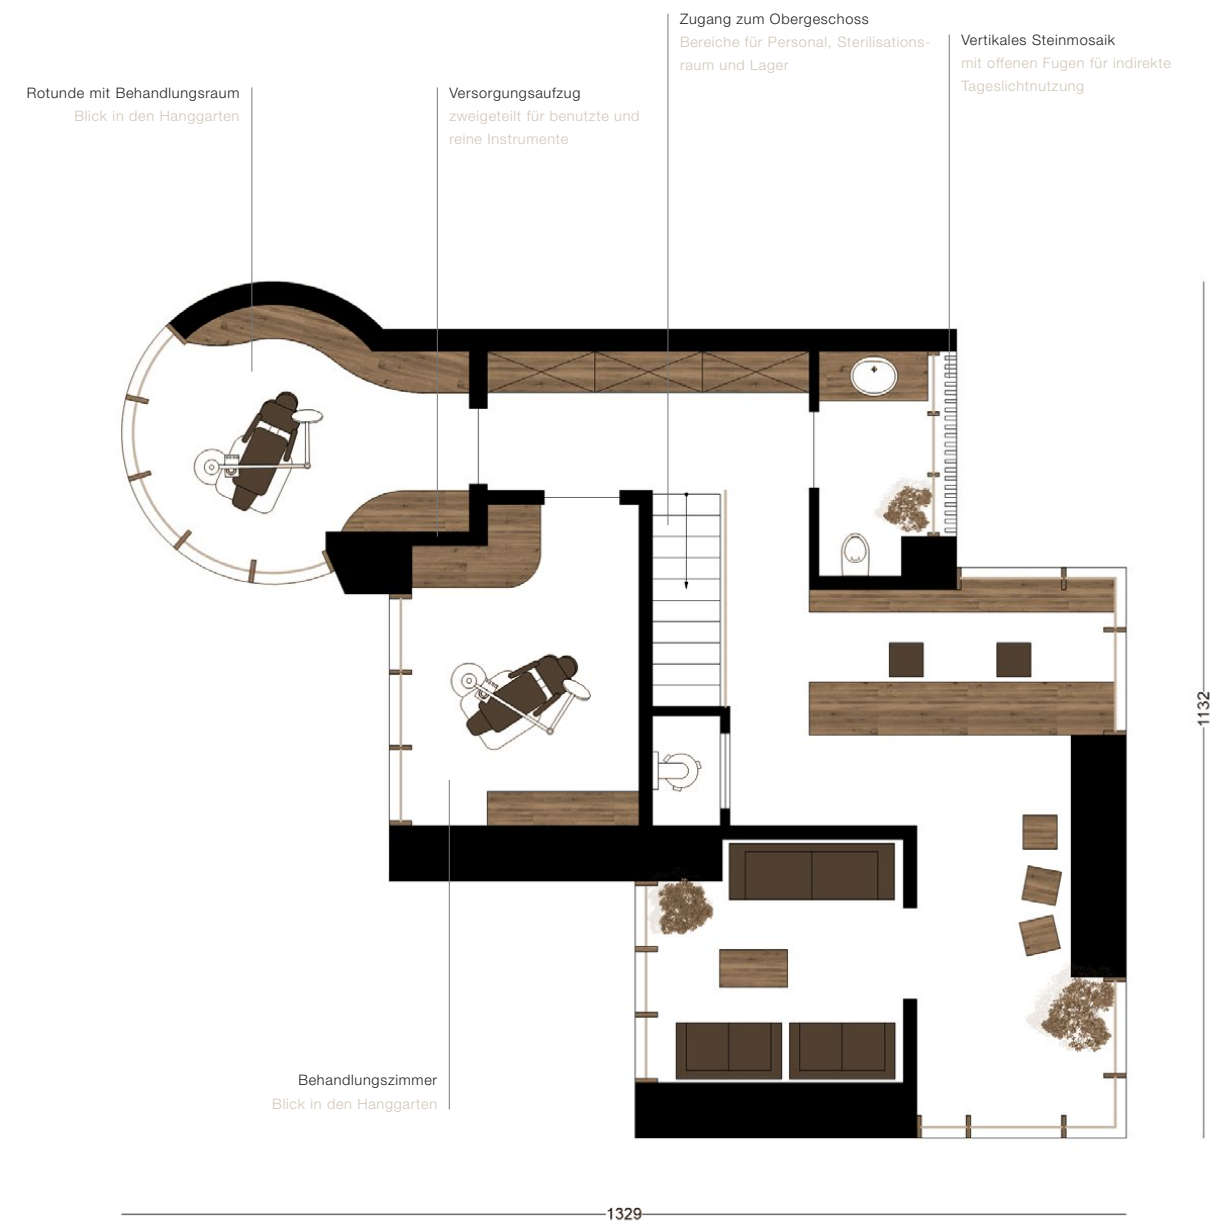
| Praxis, Grundriss (Erdgeschoss)
